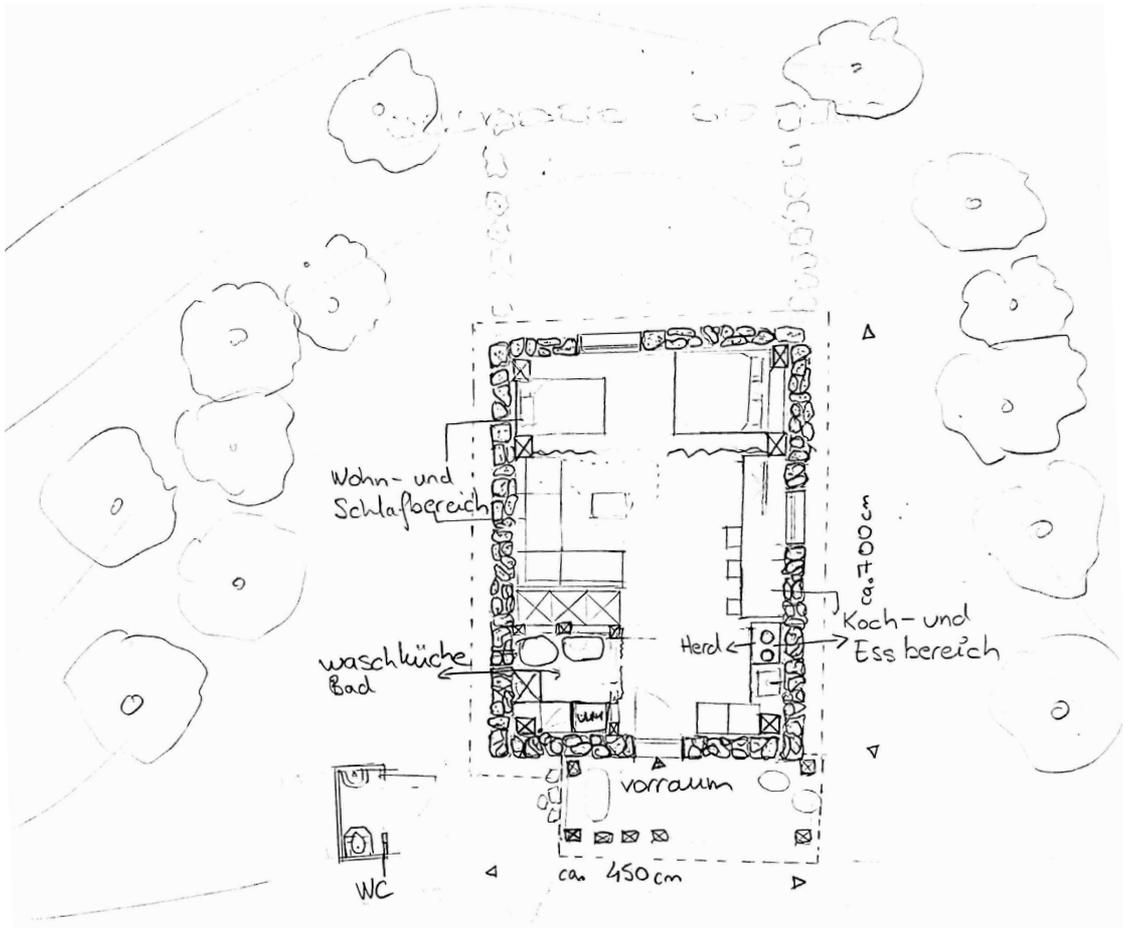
Beispielgrundriss einer selbstgebauten Kasolle.
